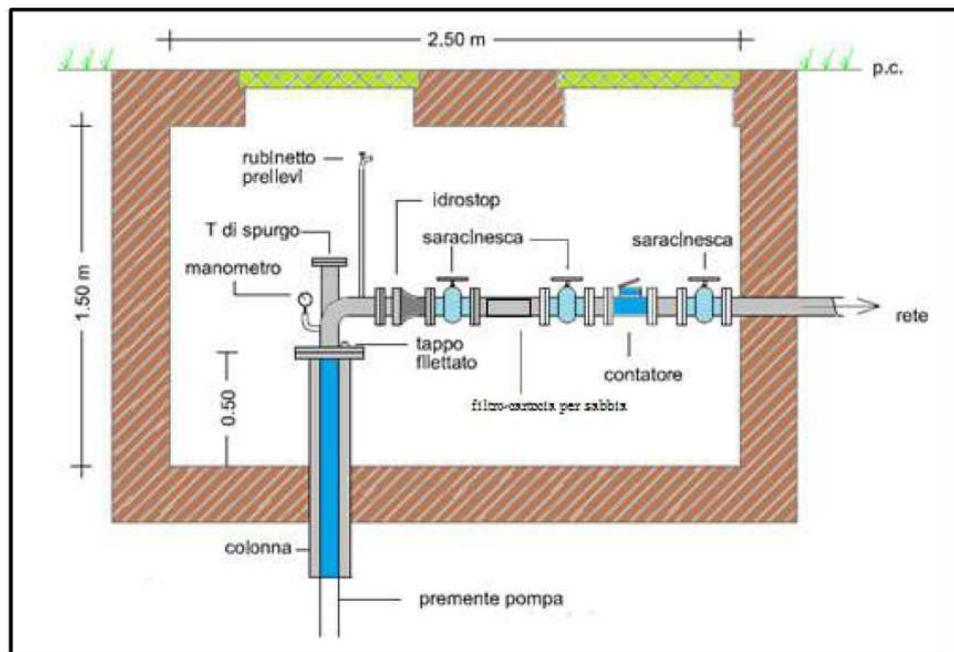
schema costruttivo della cameretta avampozzo a protezione del pozzo di presa in progetto; non rappresentato il termometro.
